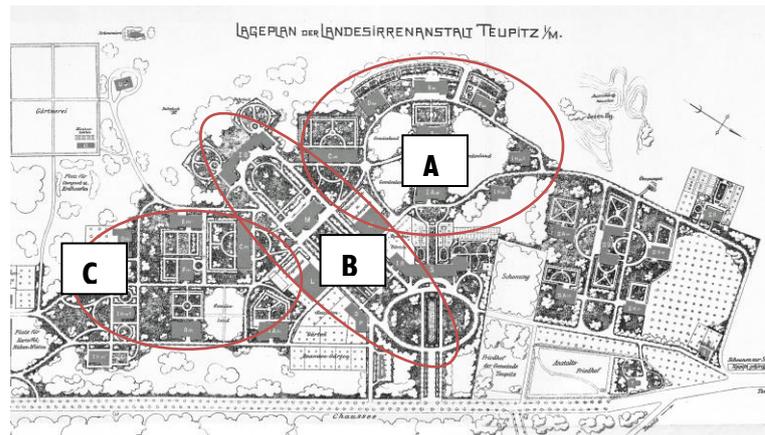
Lageplan der Landesirrenanstalt Teupitz 1907
